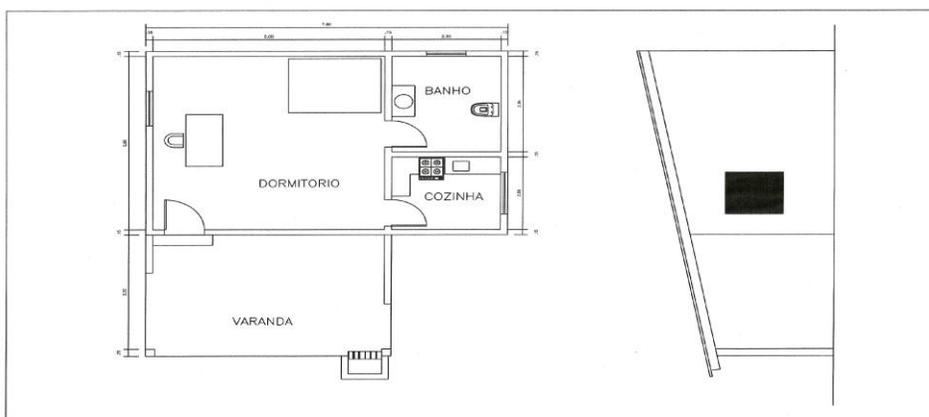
Planta Baixa e vista frontal da casa elementar proposta por Meneghetti, 2005.
